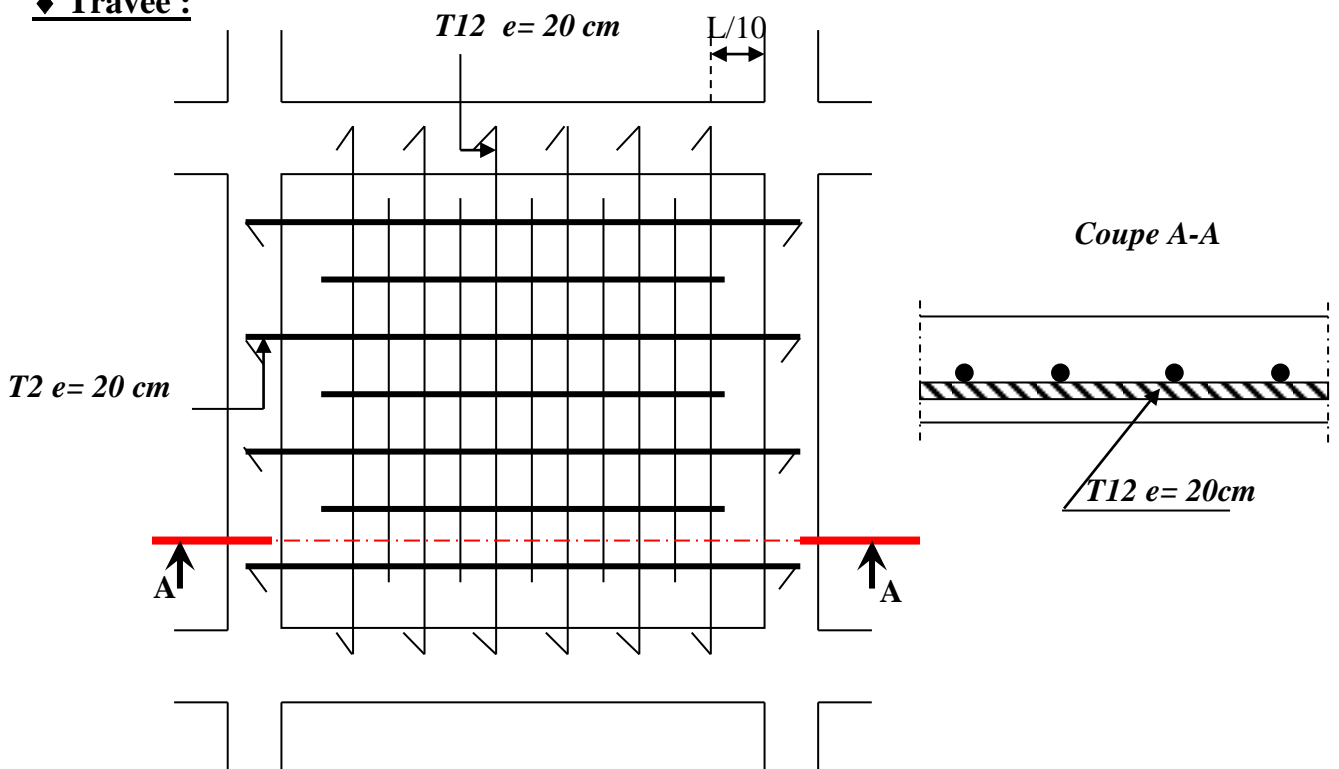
Croquis du ferrailage : (exemple Dalle étage courant) :
